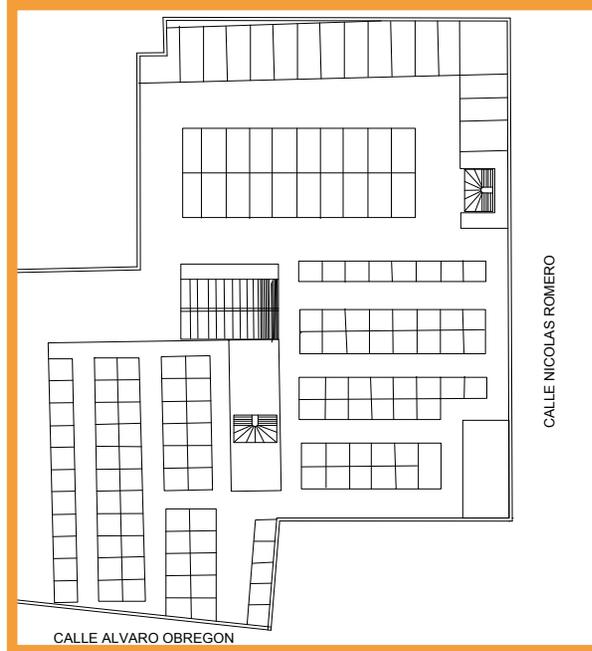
Planta del mercado Tariacuri nivel 1
